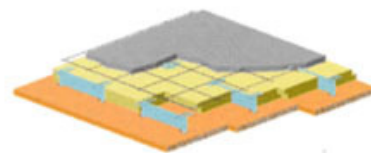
Schema assometrico di copertura Wood Beton Evoluzione.
